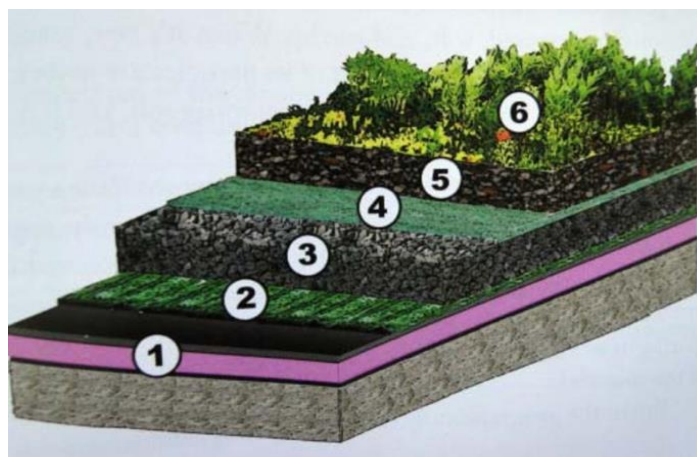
Componentes de um telhado verde. 1) Pavimento do telhado, isolamento e impermeabilização. 2) Proteção e camada de armazenamento. 3) Camada de Drenagem. 4) Camada anti-raízes, filtro permeável. 5) Camada de substrato, 6) Vegetação.
